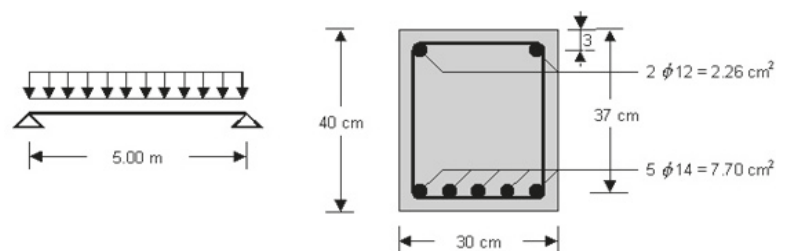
Trave in c.a. dell'esempio numerico: (a) schema di carico e (b) sezione trasversale
